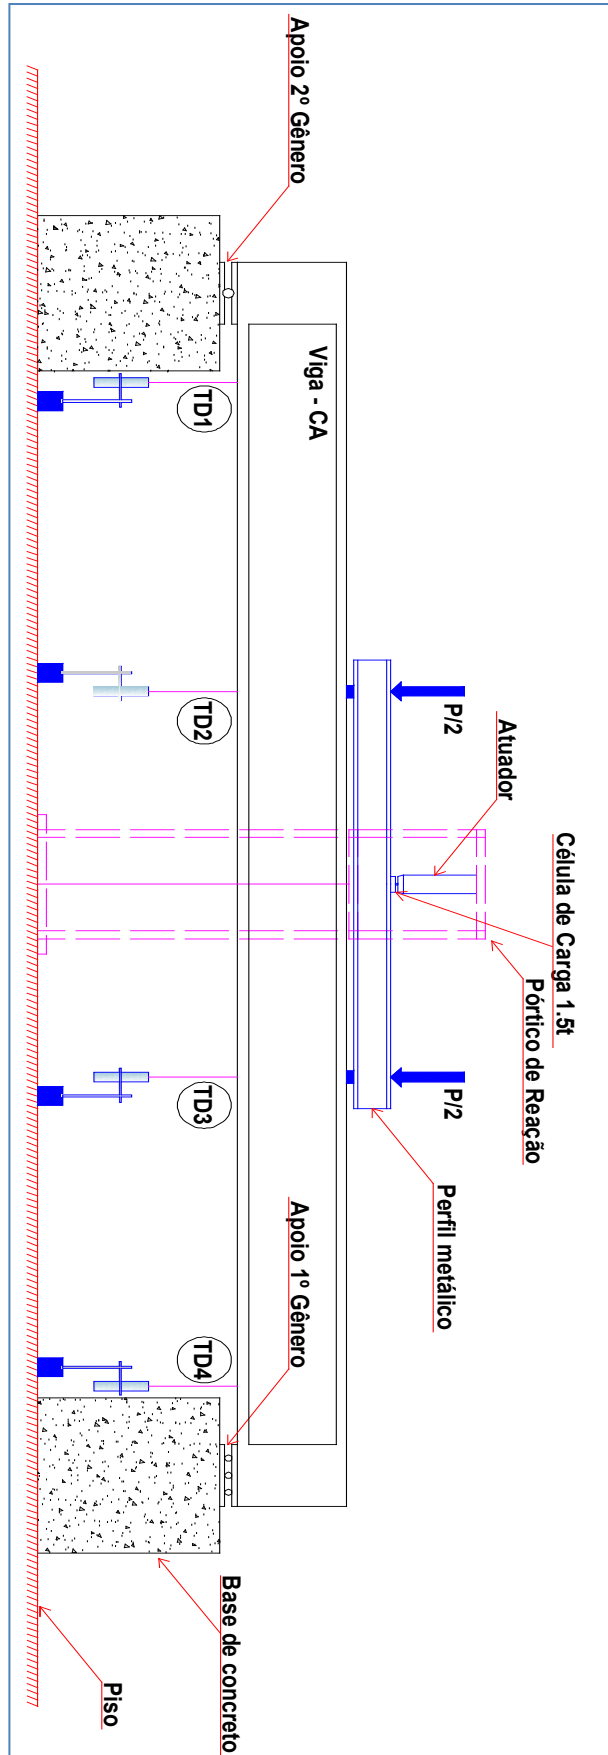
Disposição esquemática dos transdutores de deslocamento e do sistema de aplicação do carregamento – Ensaio estático do modelo de viga
